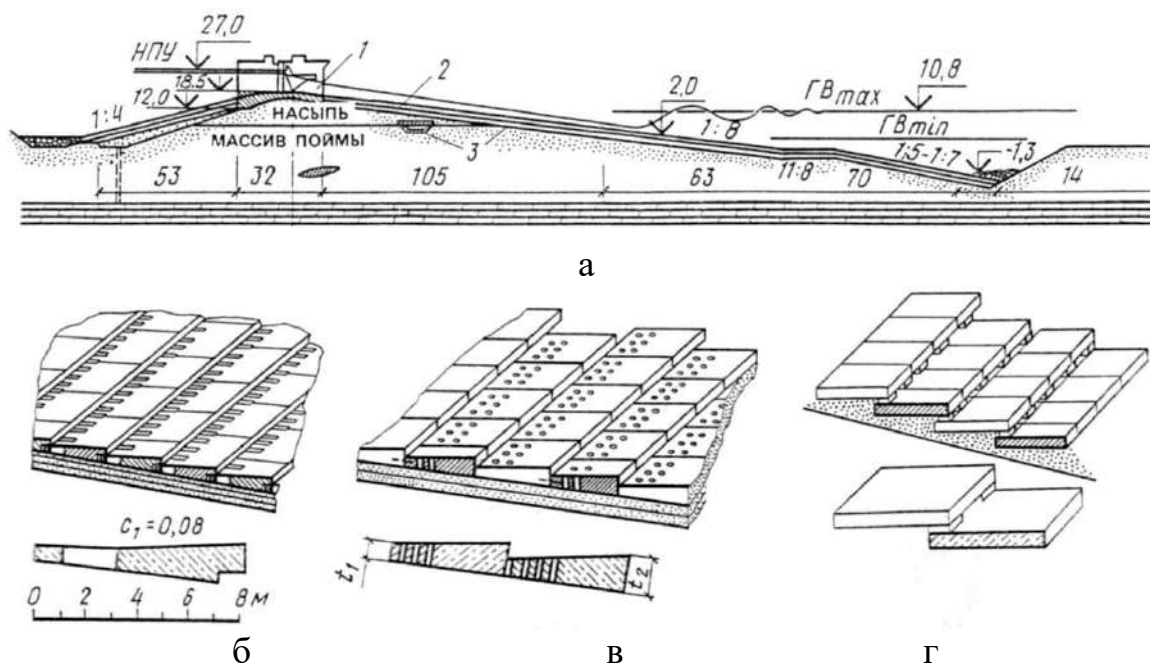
Водосливно-бетонно-грунтовая плотина с
